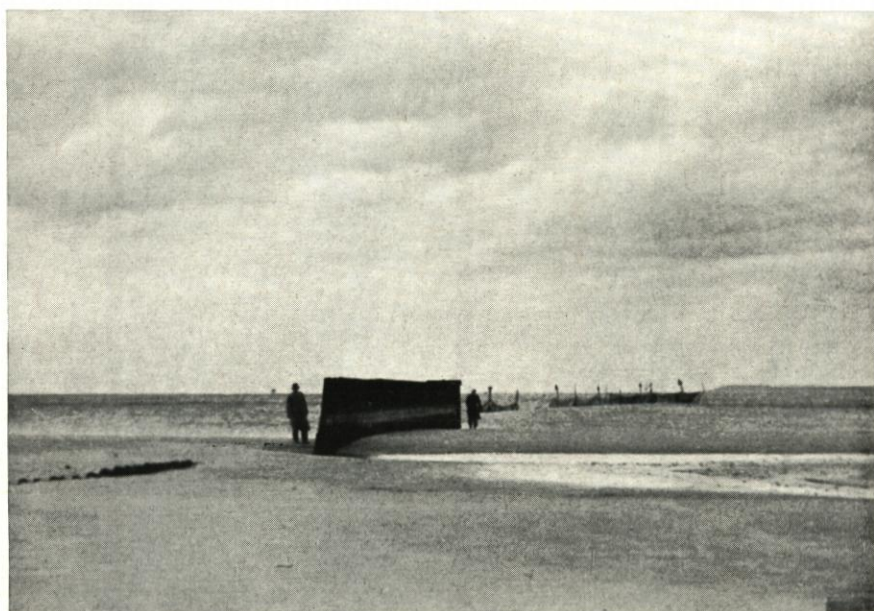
Die gleiche Bühne wie auf Abb. 38. Seeseitiger Teil, Mittelstück abgebaut
